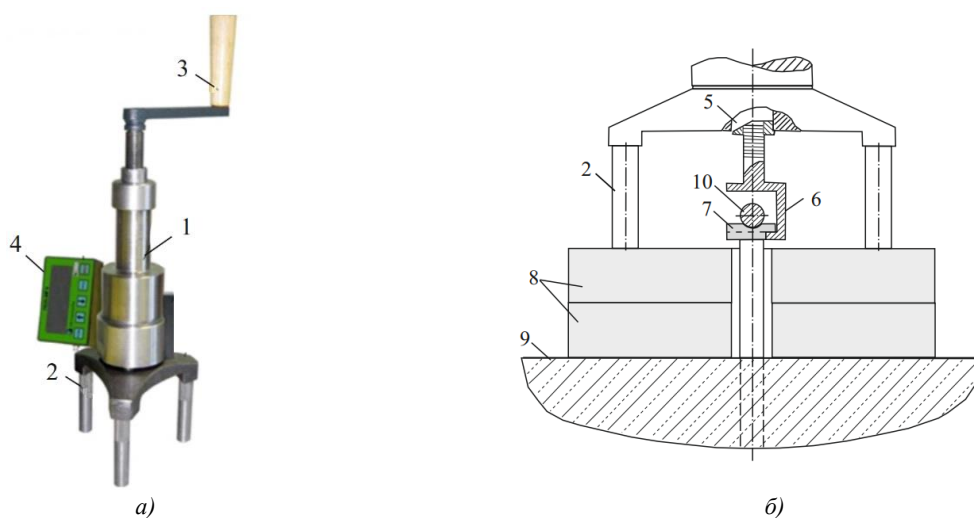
Общий вид прибора ПСО-10МГ4АД (а) и схема его применения при проверке прочности строповочных петель (б): 1 — силовозбудитель; 2 — опора; 3 — рукоятка нагружения; 4 — электронный блок; 5 — шток силовозбудителя; 6 — захват; 7 — ложемент; 8 — алюминиевая пластина; 9 — плита покрытия; 10 — строповочная петля
